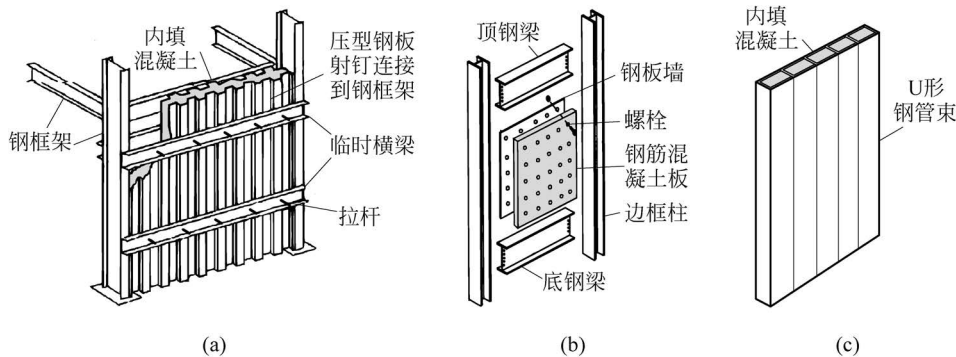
其他各类钢板与混凝土组合所形成的墙体结构示意图
